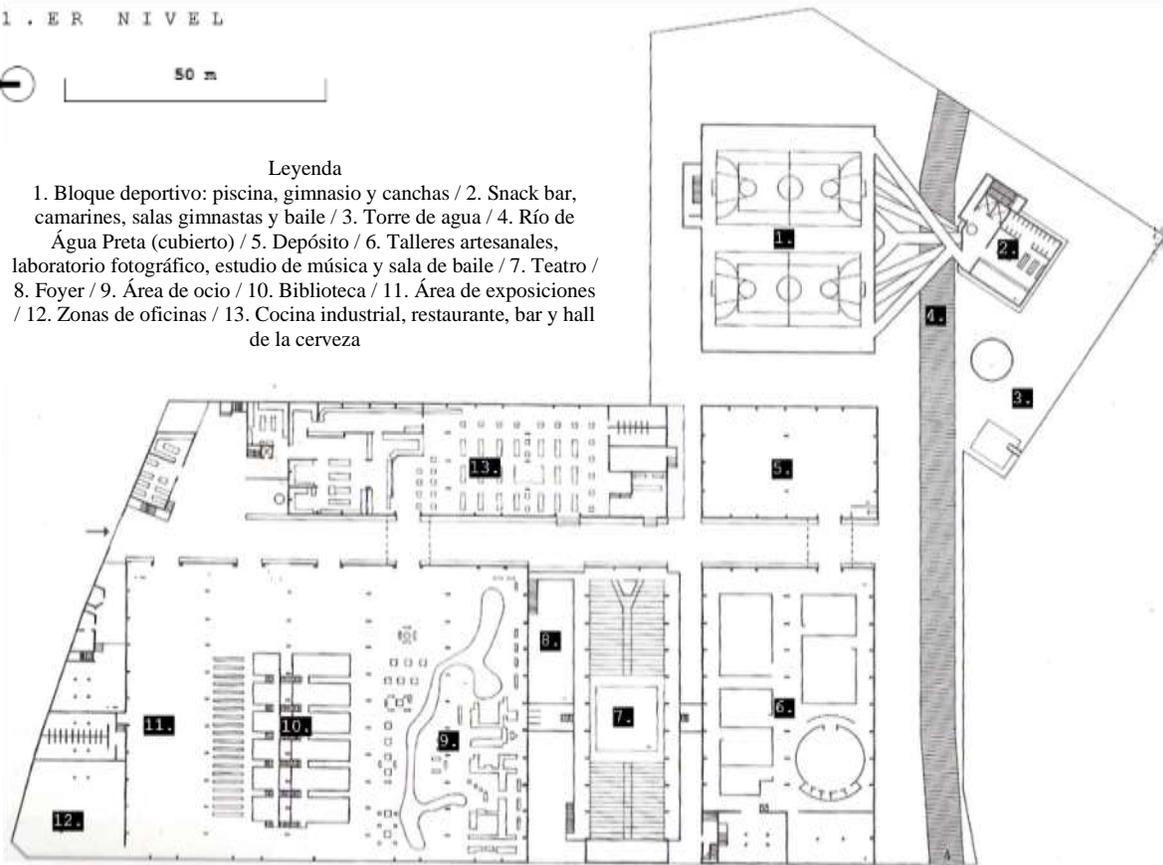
Planta general del SESC Pompéia. (Pinterest, s.f)
